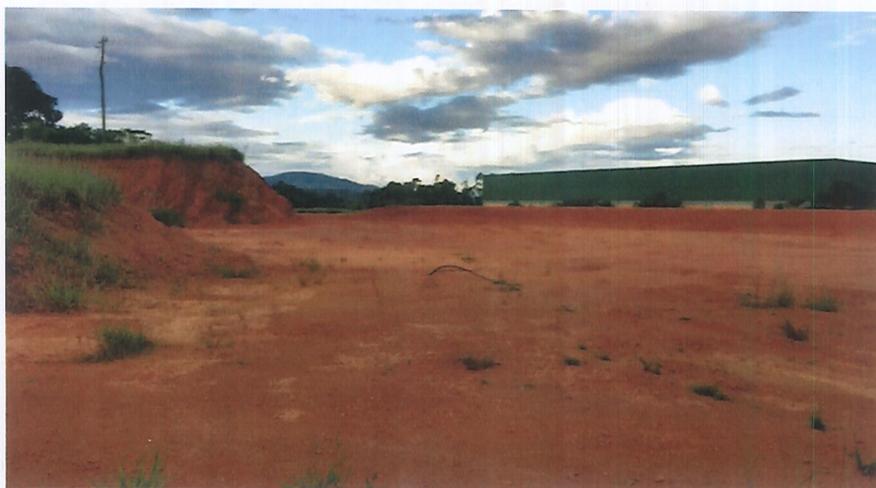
Nova vista parcial do imóvel; detalhe para a terraplenagem executada no terreno.
